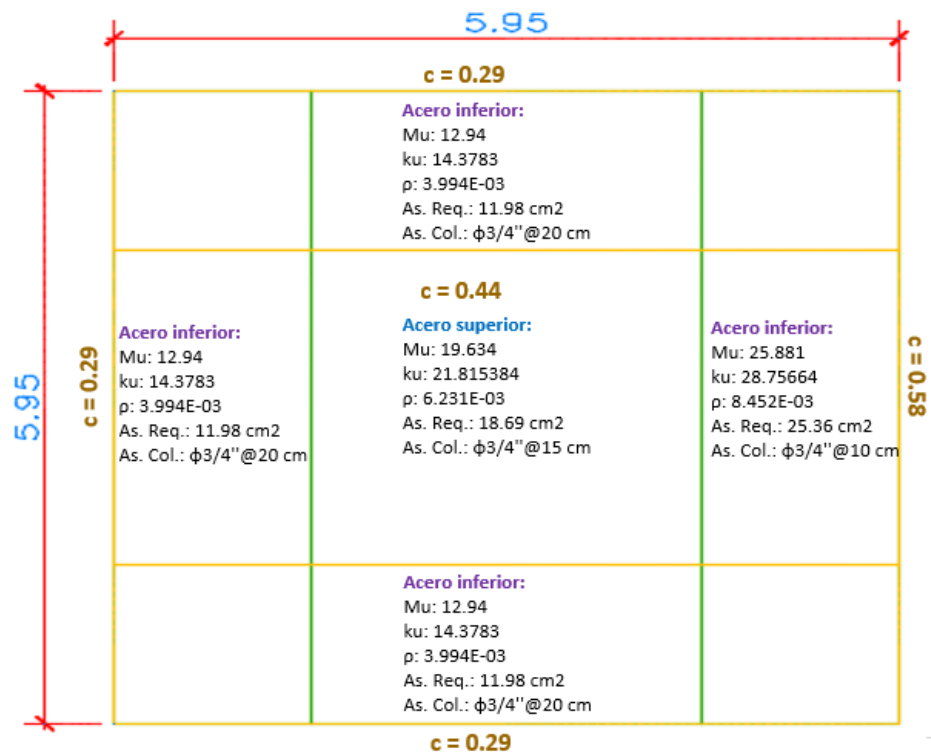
As de la losa - Losa de cimentación con viga - Sistema dual tipo II
